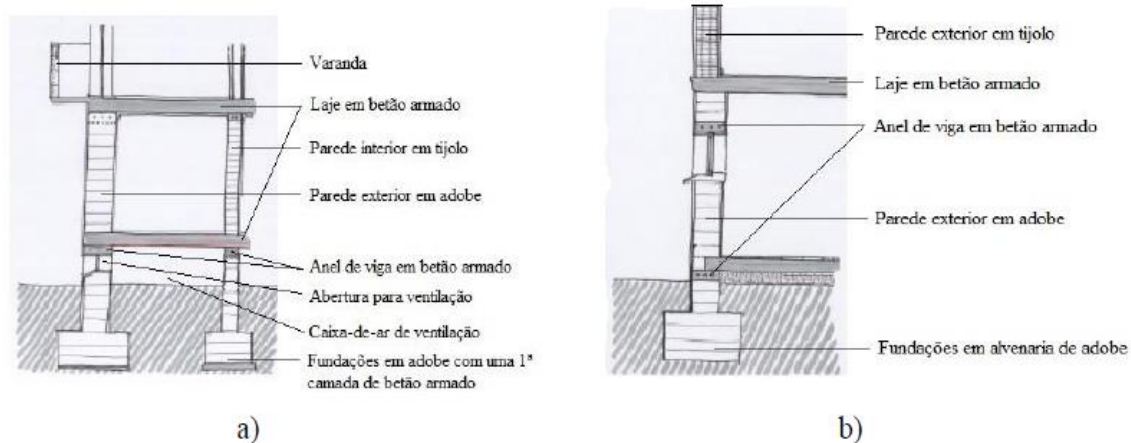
a) Sistema lajes em betão armado; b) Sistema híbrido. (adaptado de Tavares et al., (2012) b)).
